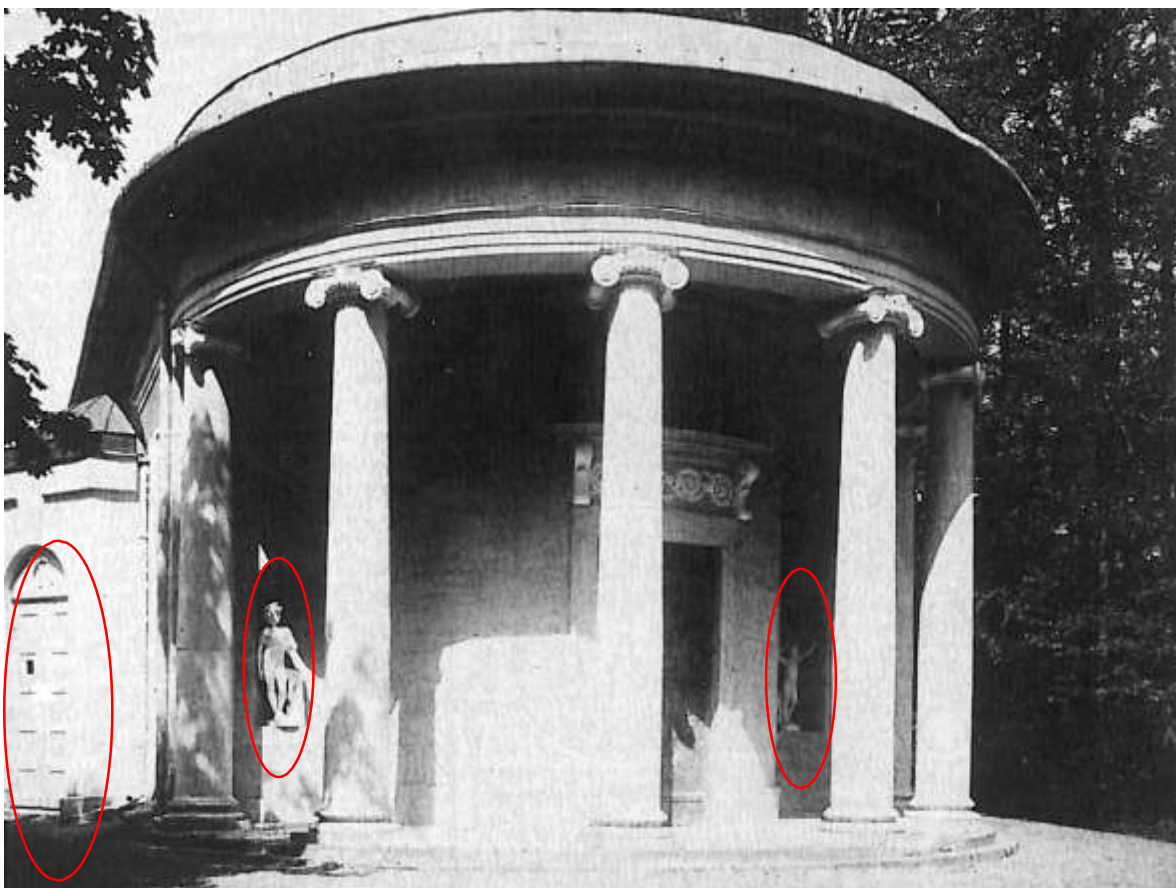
Elewacja S -fragment. Wykuszt sypialni. Stan po remoncie dachu 1958_1965_Foto_Arkadia MNA1722
